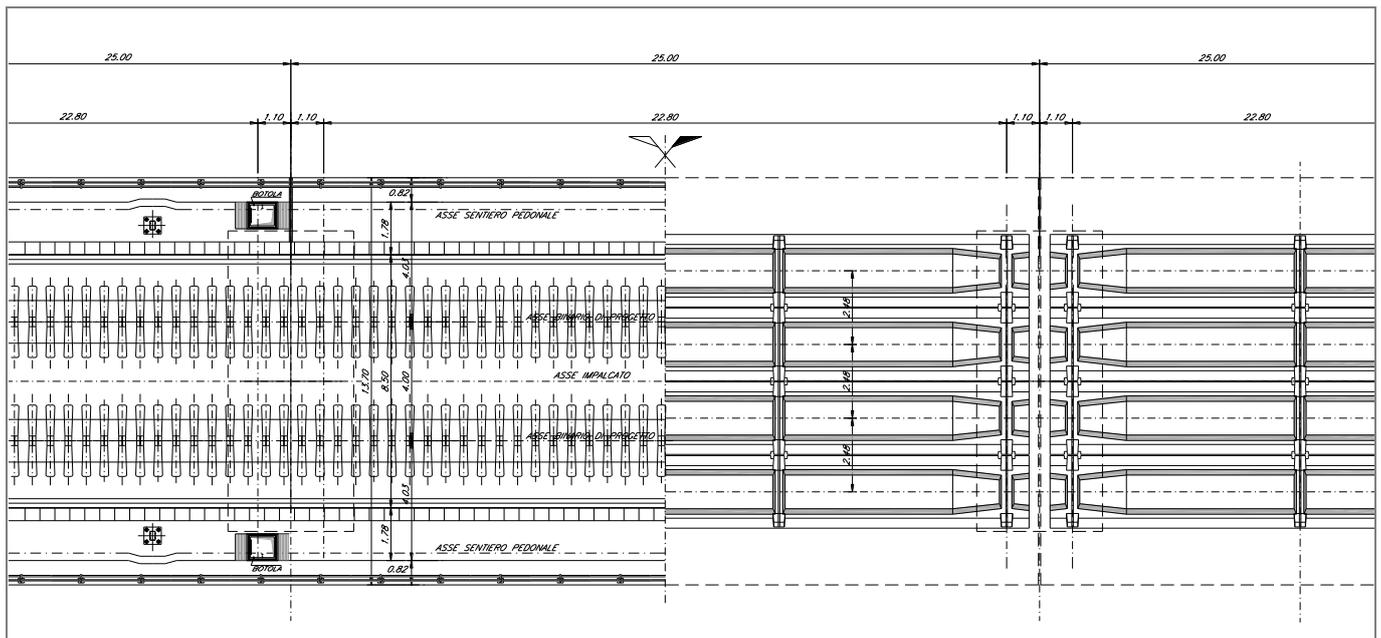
Pianta tipo viadotto c.a.p. L=25.00m
